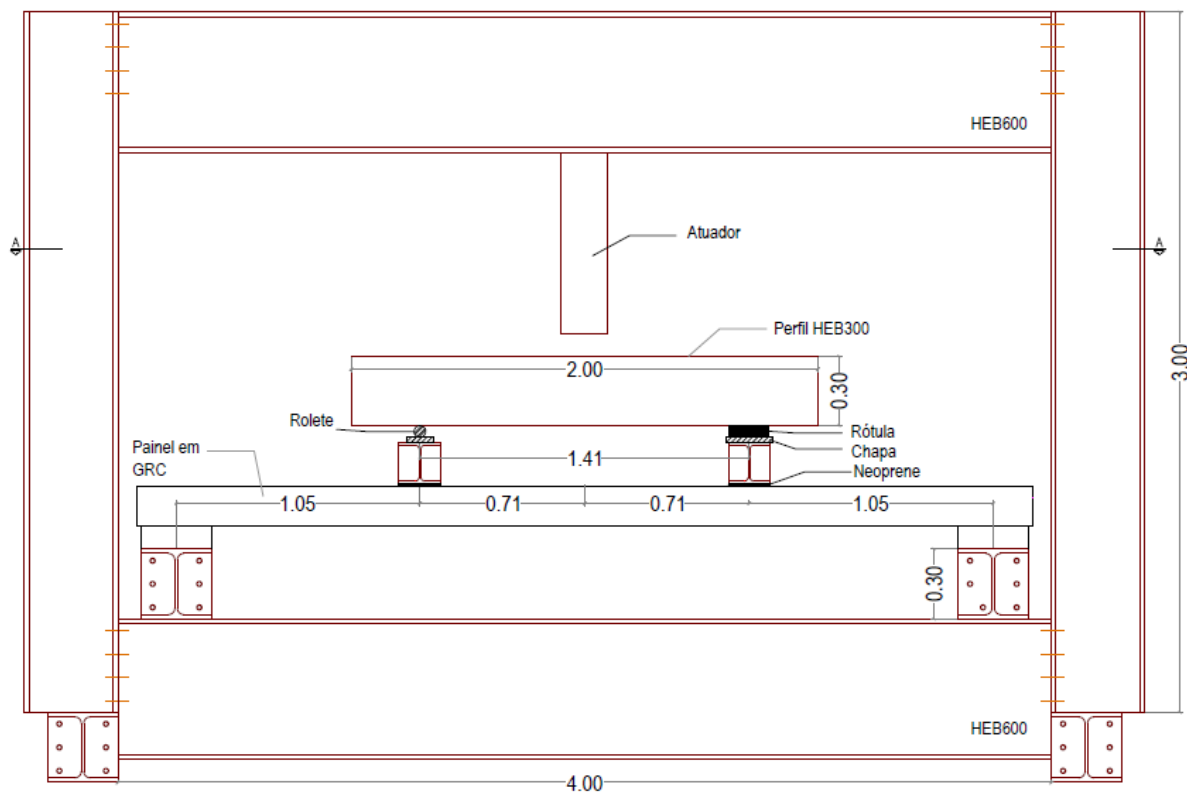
Vista lateral do esquema do ensaio preliminar (dimensões em m)
